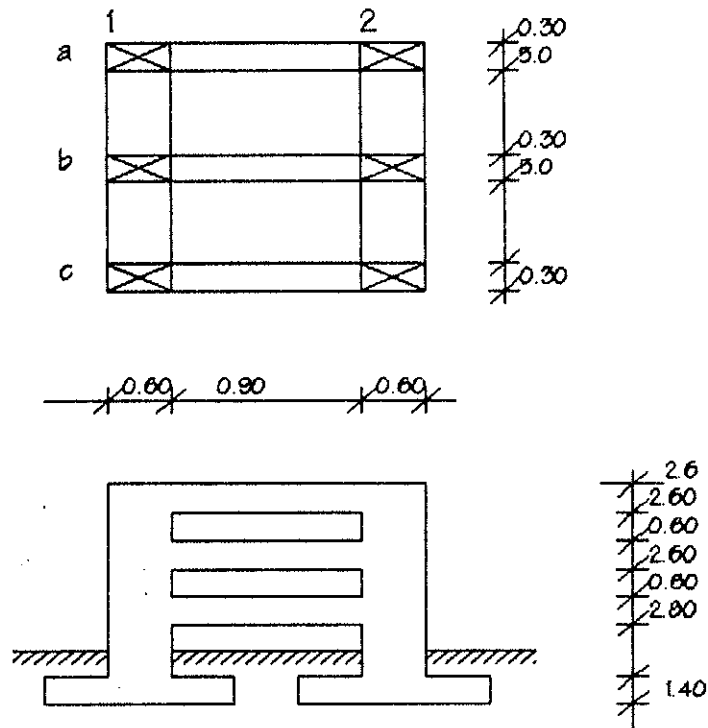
(Son todas las estructuras que llevan forro de lámina en las paredes).
